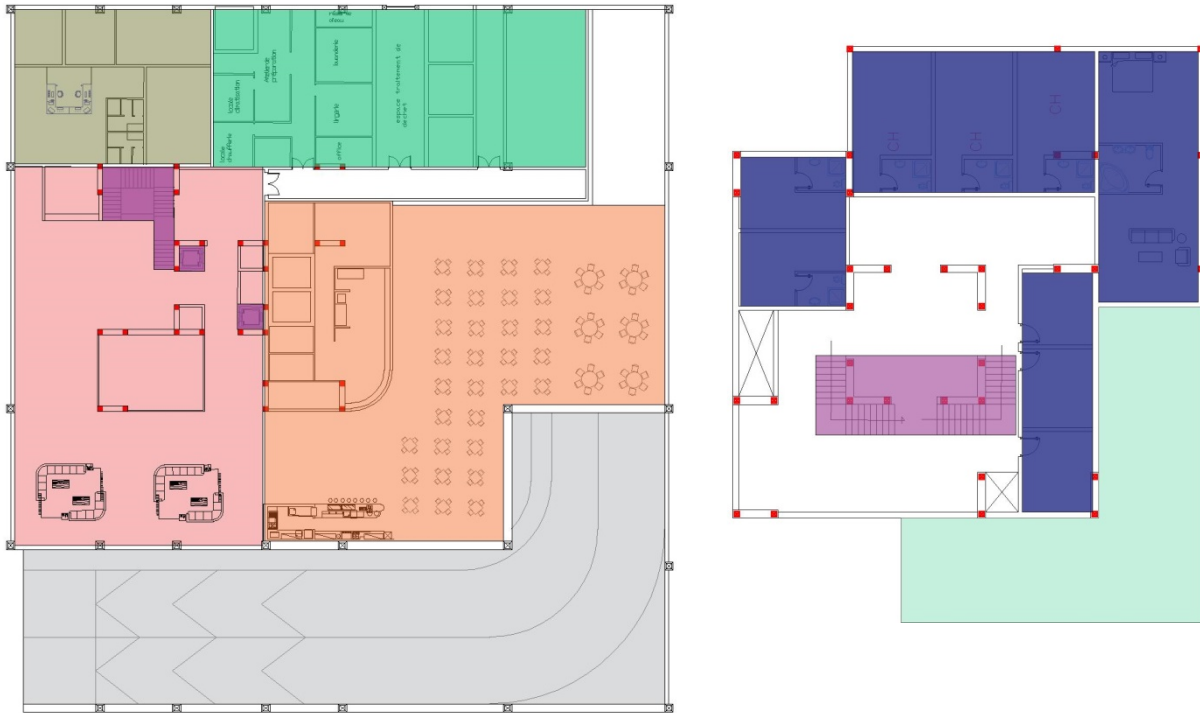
Plan socle de la tour; plan étage courant; Source : Auteurs
